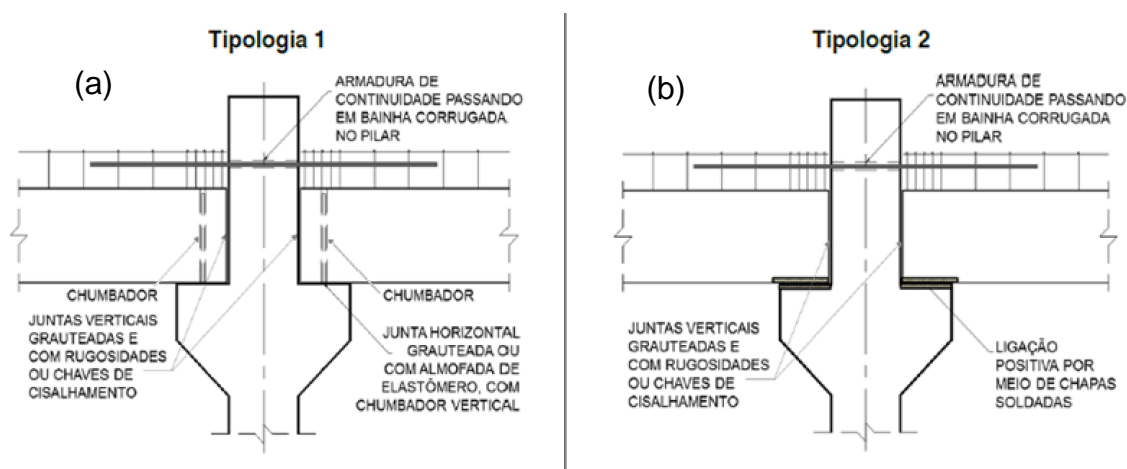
T&A Pré-fabricados – Estruturas em esqueleto
